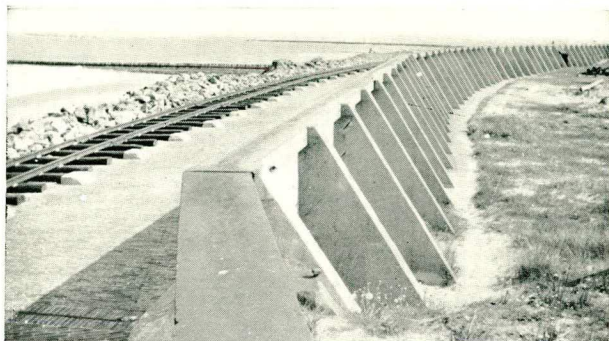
Strandmuur voor het vliegveld tussen de haven en hoofd G.
